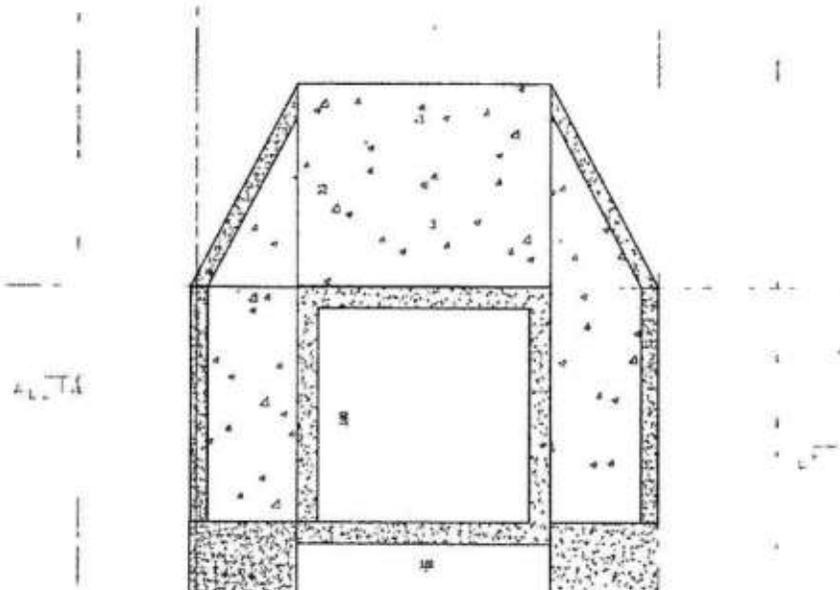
Perfil transversal de box culvert de 3.0x3.0m del Tramo Vial La Gloria – La Mata
